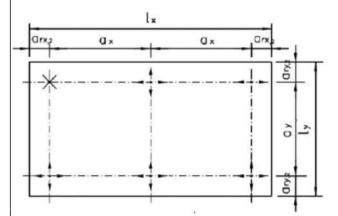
Fassadenplatte mit 6 Agraffen - Lagerungsart 3
